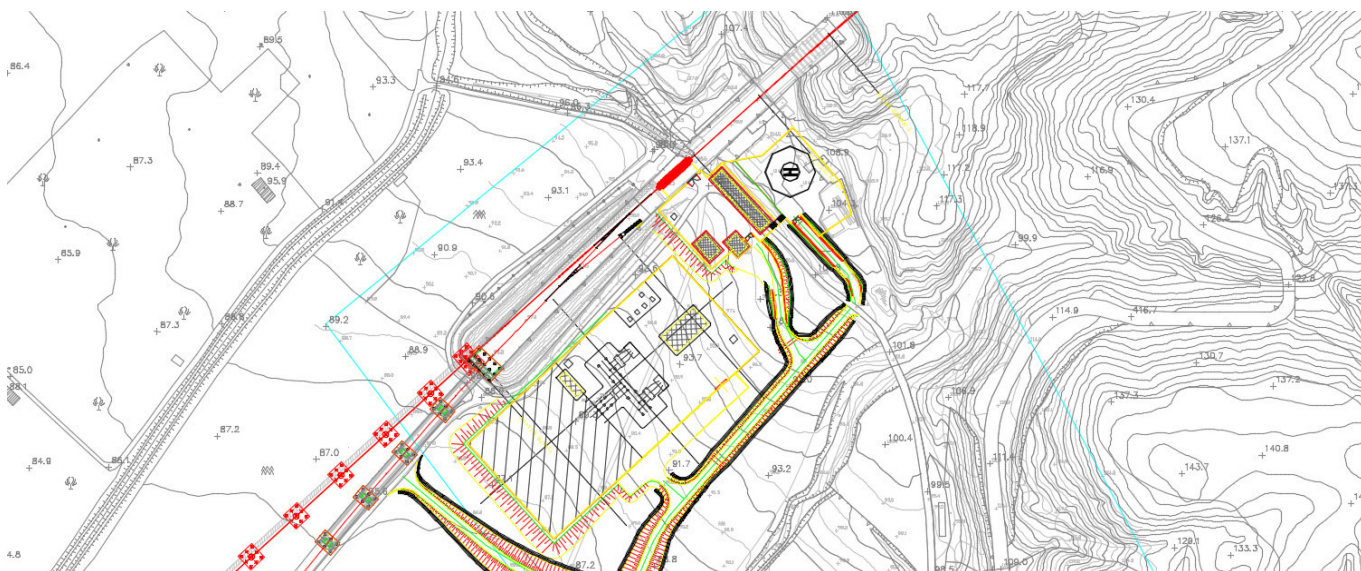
Stralcio planimetria SSE Ferrandina (MT)
